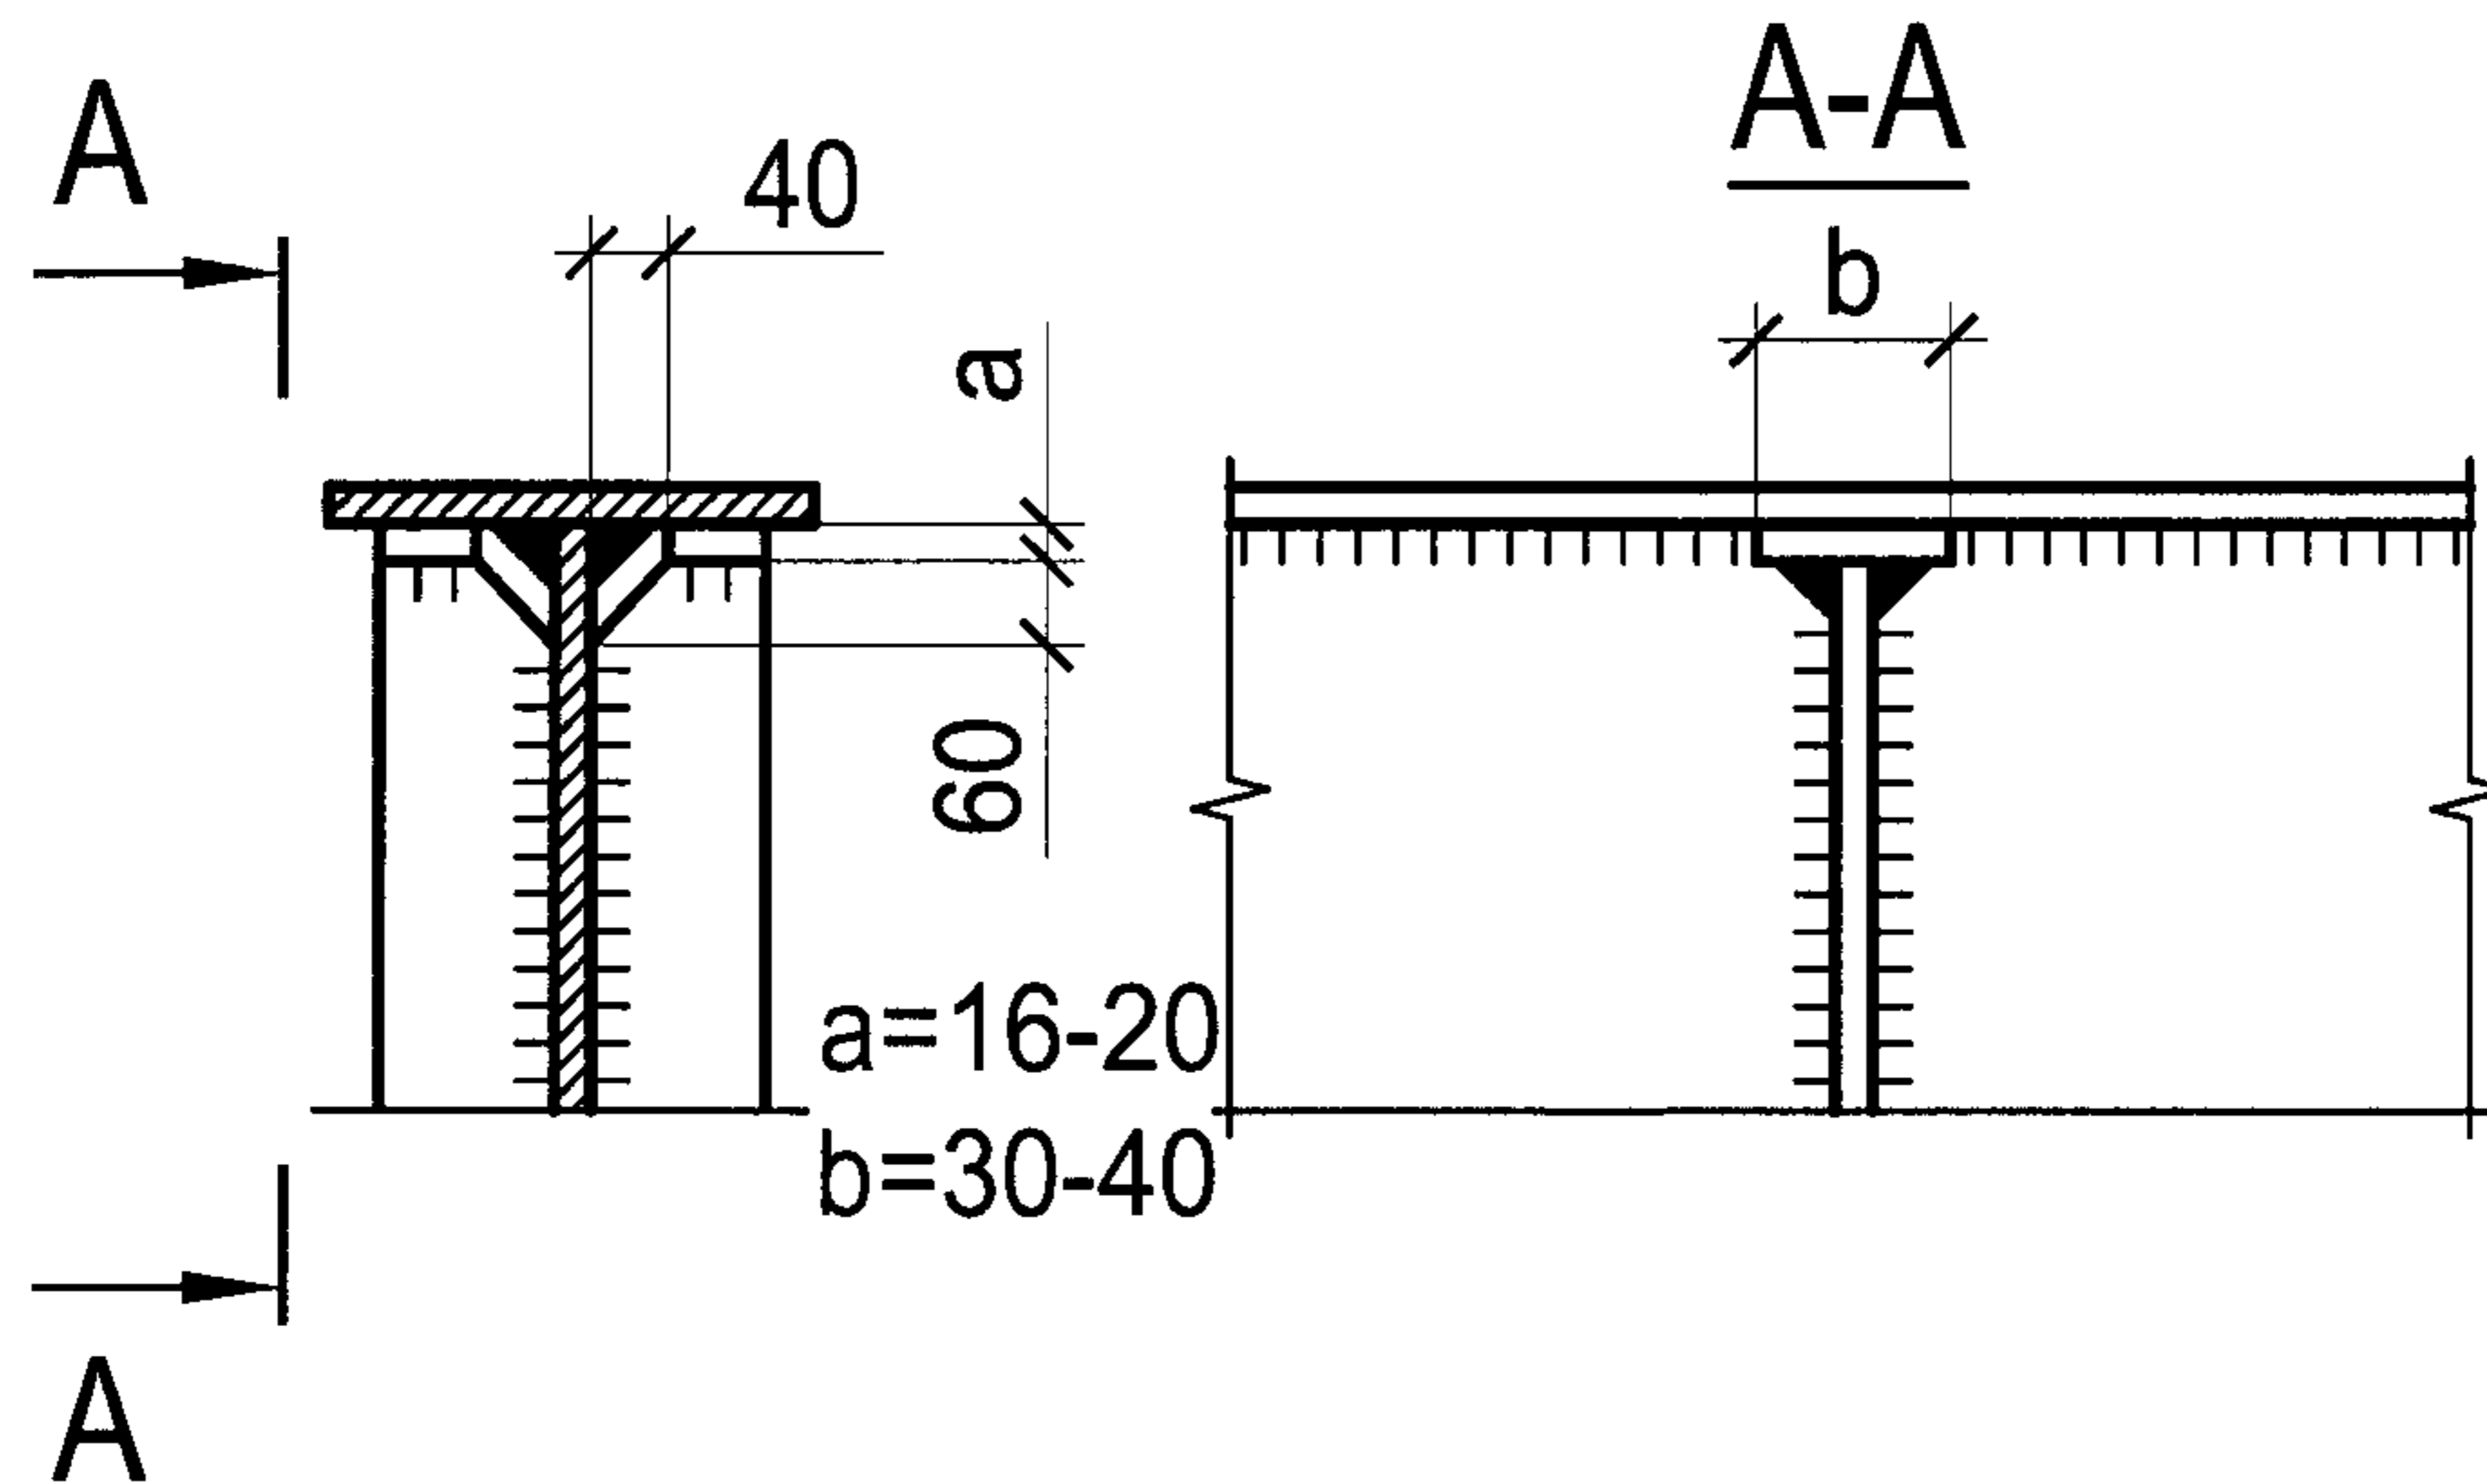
Примыкание ребер жесткости к поясам балки.
